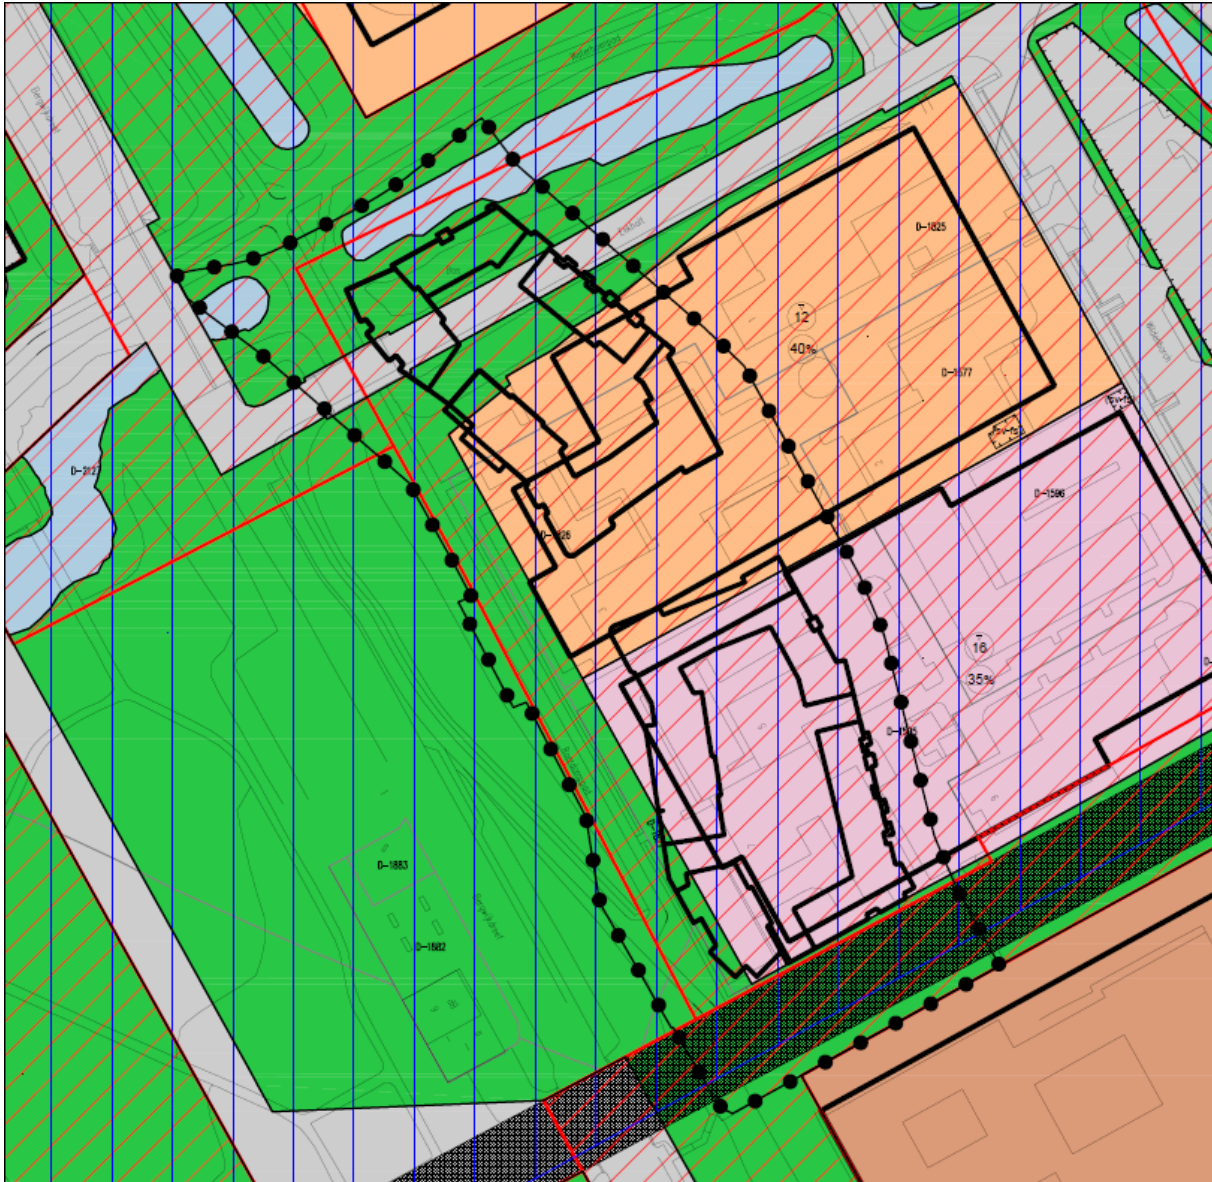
B Groen(voorzieningen) en water in het gebied Bergwijkpark Noord en Holland Park, in het stedenbouwkundig plan. (Tekening uit het stedenbouwkundig plan "Holland Park, Urban Picturesque", december 2015)
